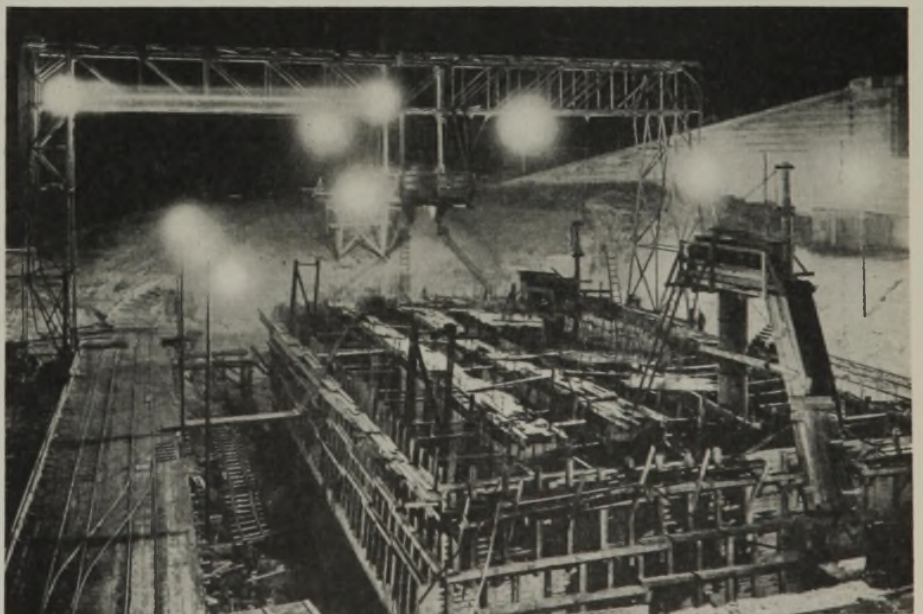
Nachtschicht am Westpfeiler. Rechts zwei Schachtrohre mit Aufzugwinde und Holzschurre für das Bodenfordern; Mitte Kran mit Betonierbühne; links Betonanfuhrgleis.
